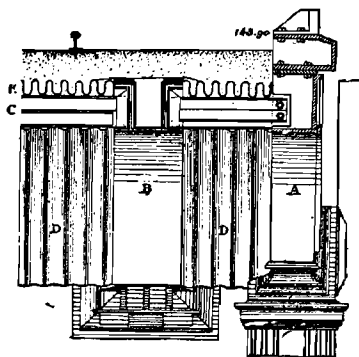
Coupe en travers faite suivant l'axe de l'ouvrage.
